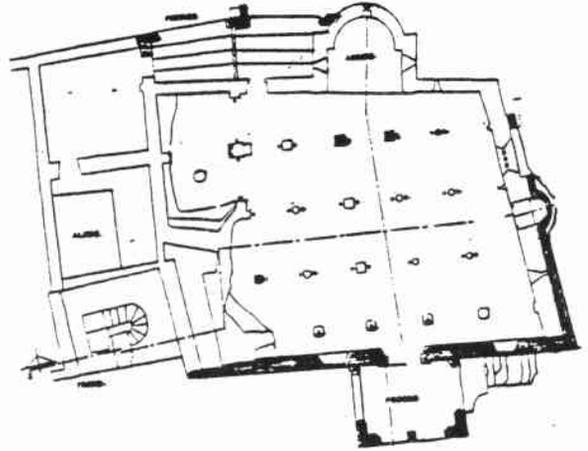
Planta de la ermita tras la reforma del S. XVI.
